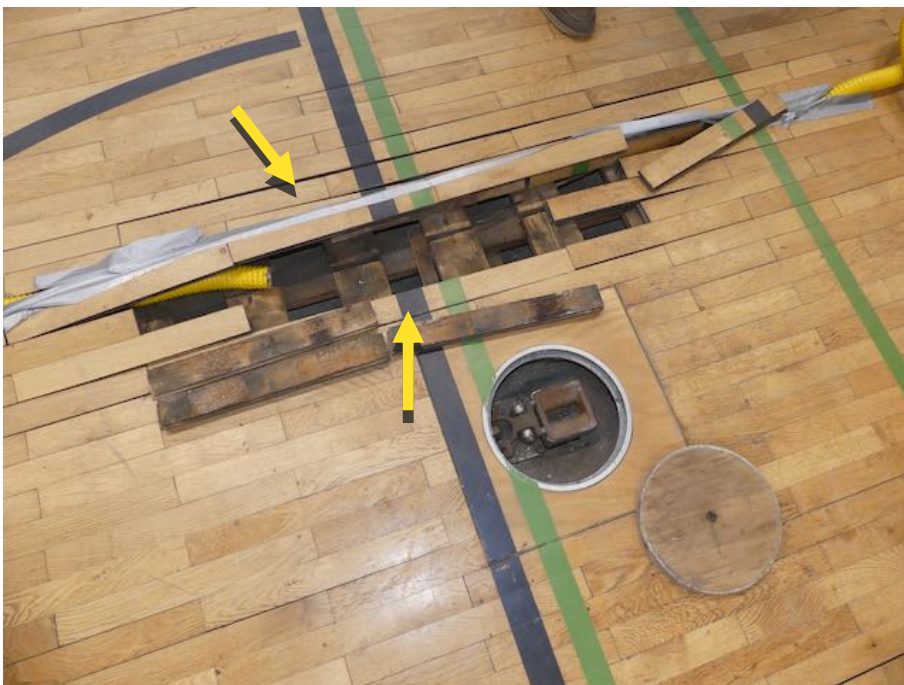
Turnhalle hinterer Teil, Gequollener Holzboden
